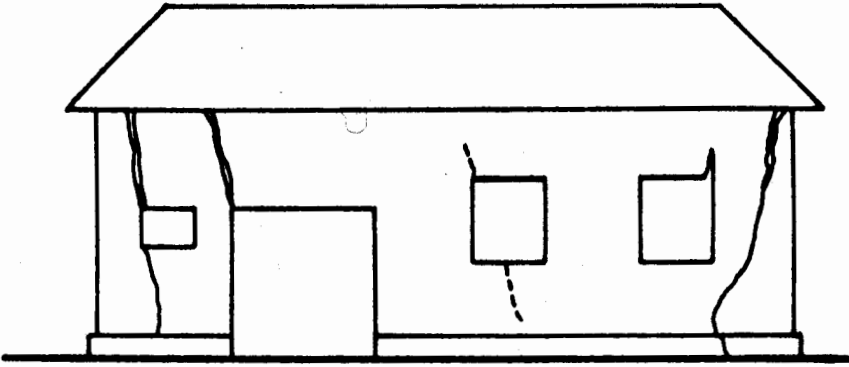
Grietas típicas producidas por una expansión horizontal del sub suelo
